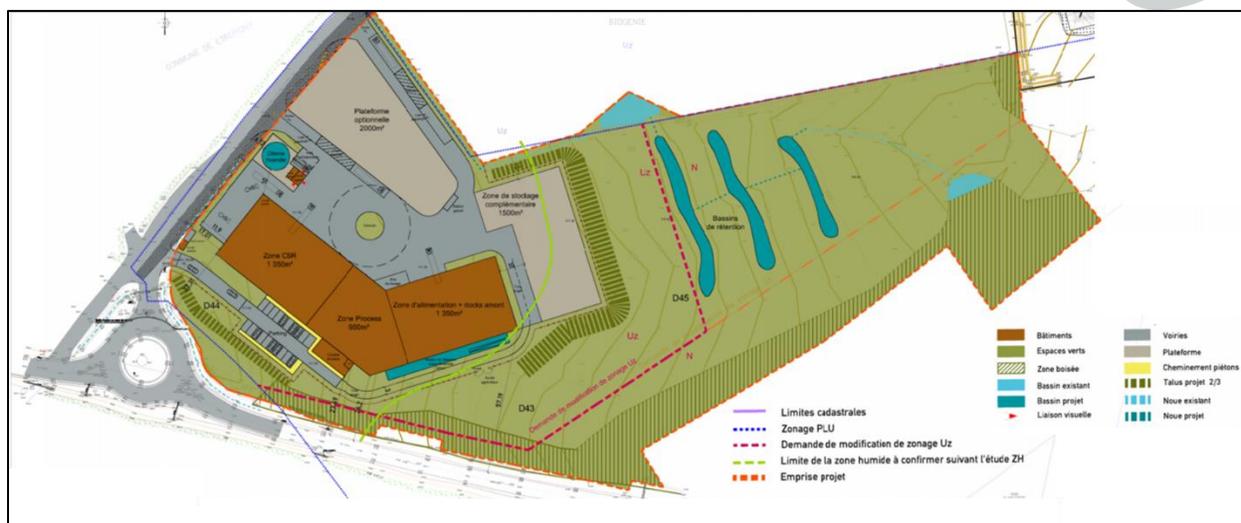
Plan de de localisation du projet - Source : ARCAVI
